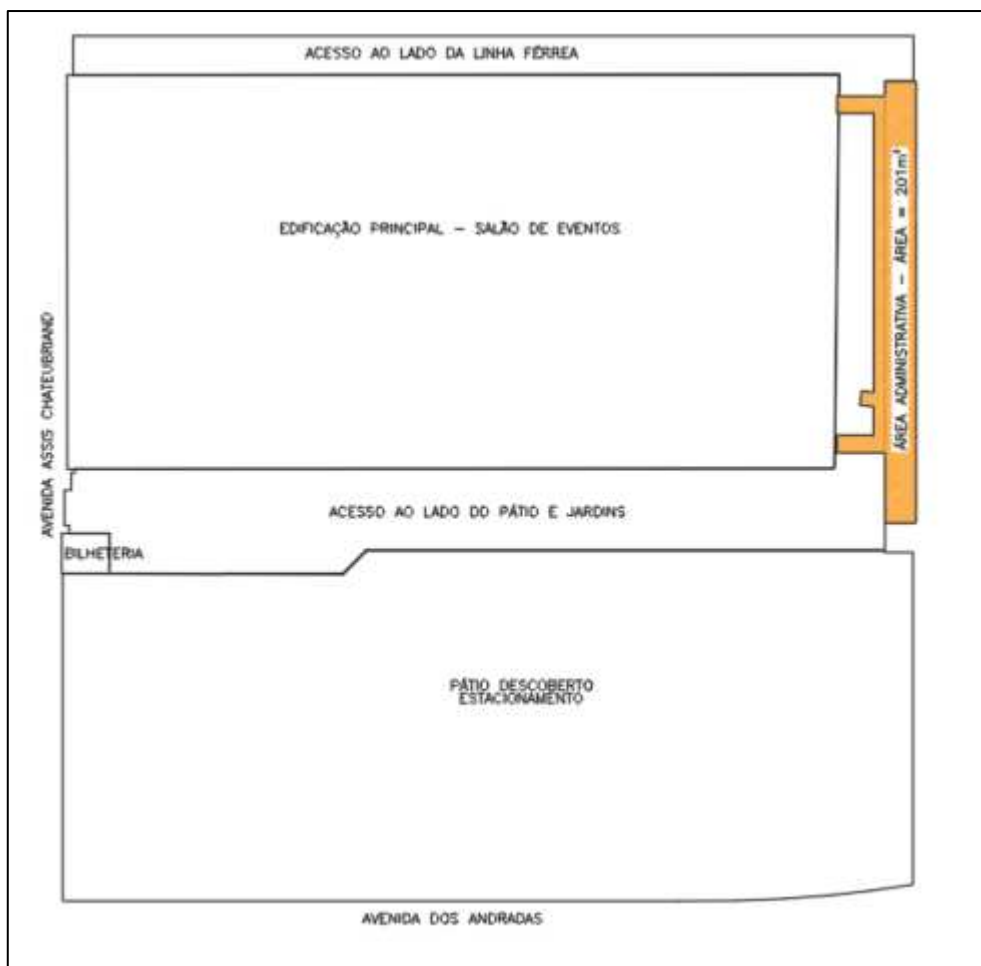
Planta chave 2º pavimento prédio administrativo.
